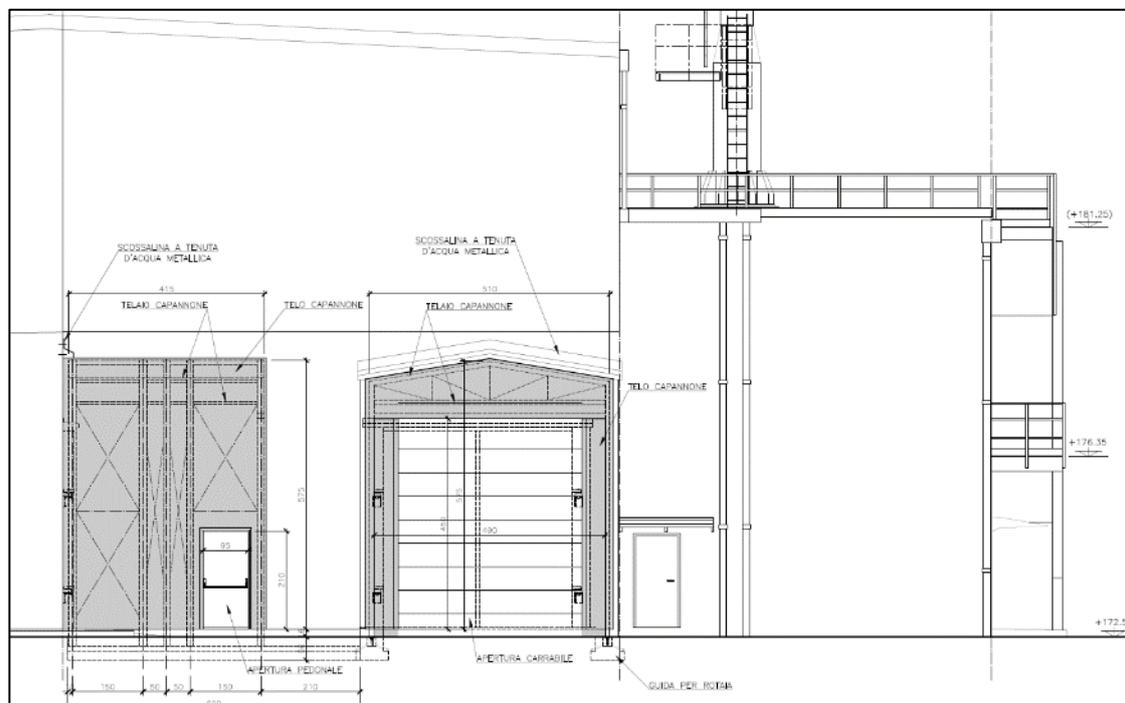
Dettaglio prospetto Est – Strutture di confinamento agli ingressi
